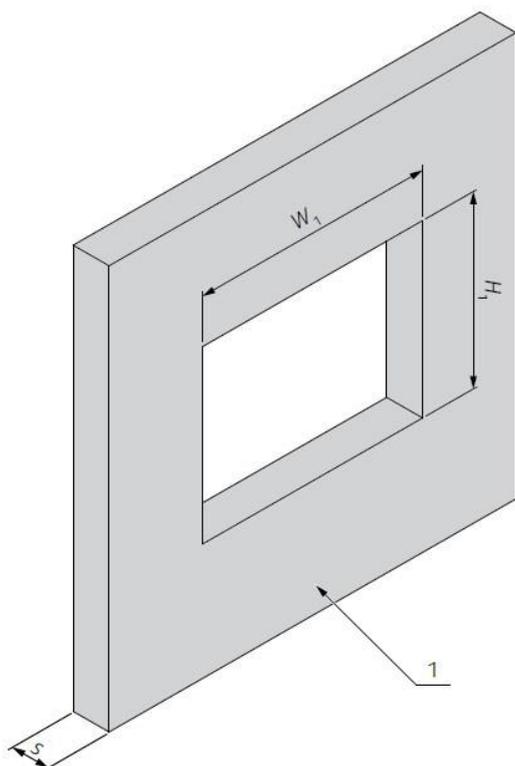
Parete/soffitto rigidi con apertura rettangolare
